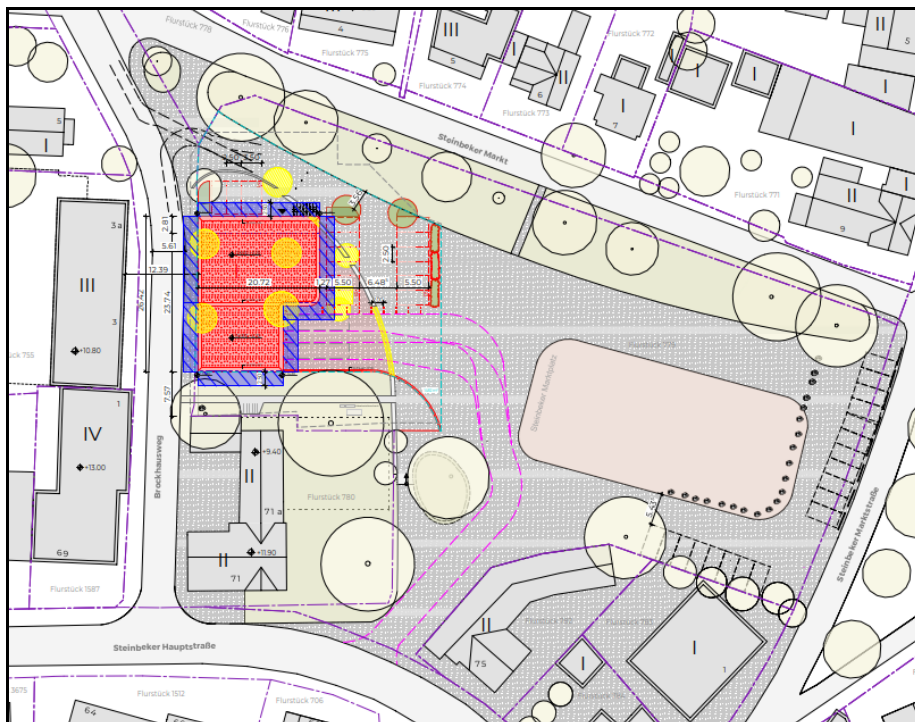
Lageplan (Quelle: Architekturbüro Pflügelbauer & Scheffczyk, Stand 12.02.2024)
